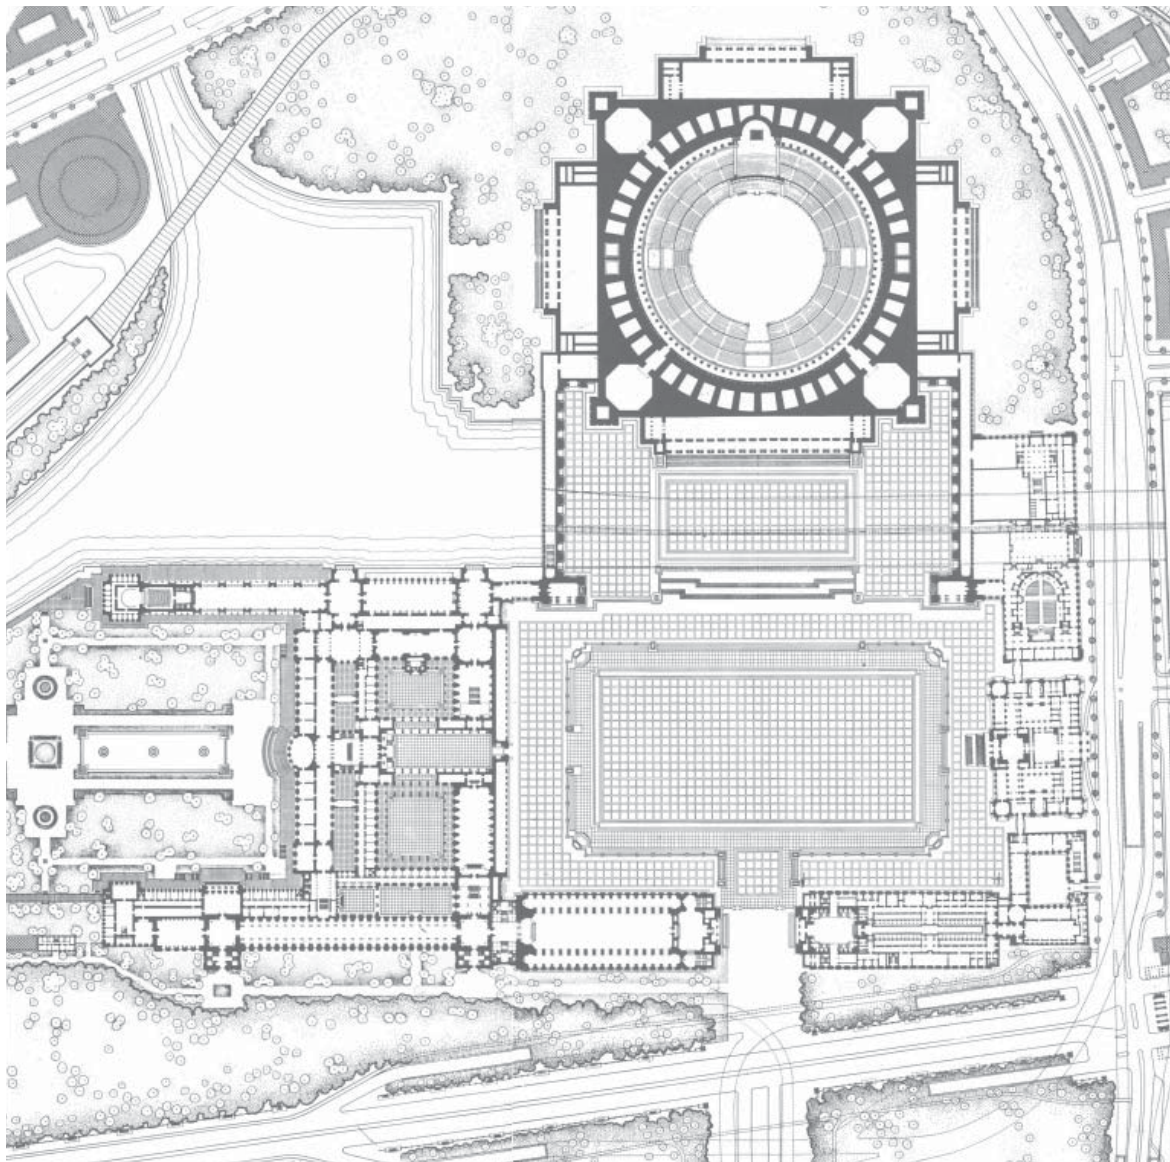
Plan de la Halle du peuple et de la Grande Place.
